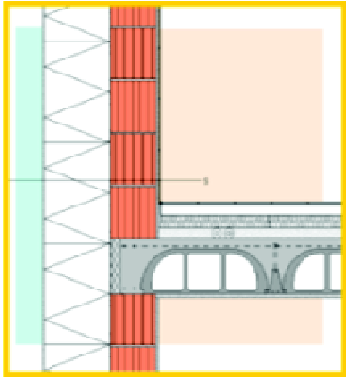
Detaliu perete exterior și planșeu curent [82]
